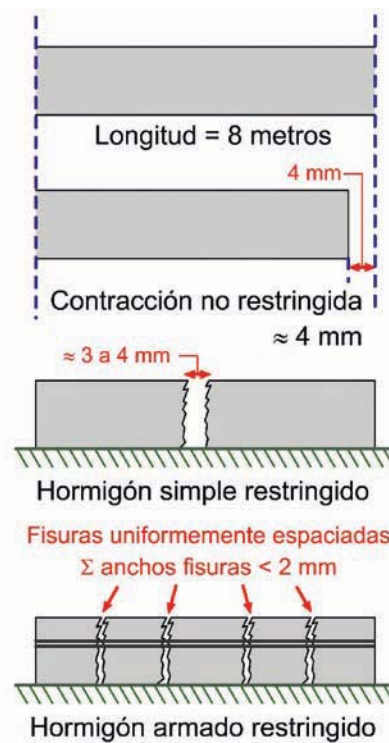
Efecto de armaduras en la distribución y disminución del ancho de fisuras
